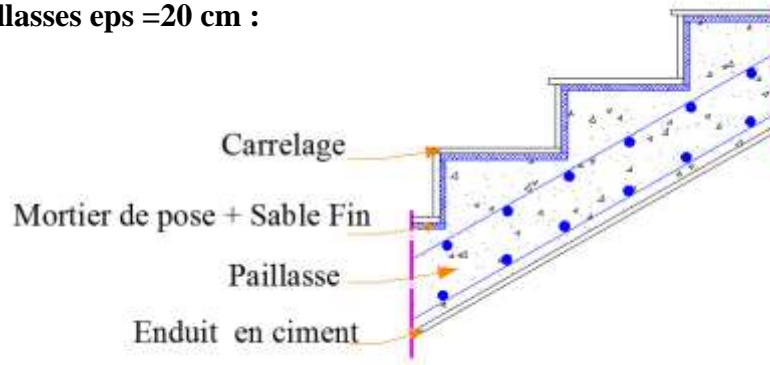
Coupe verticale de Paillasse (Dalle pleine)
